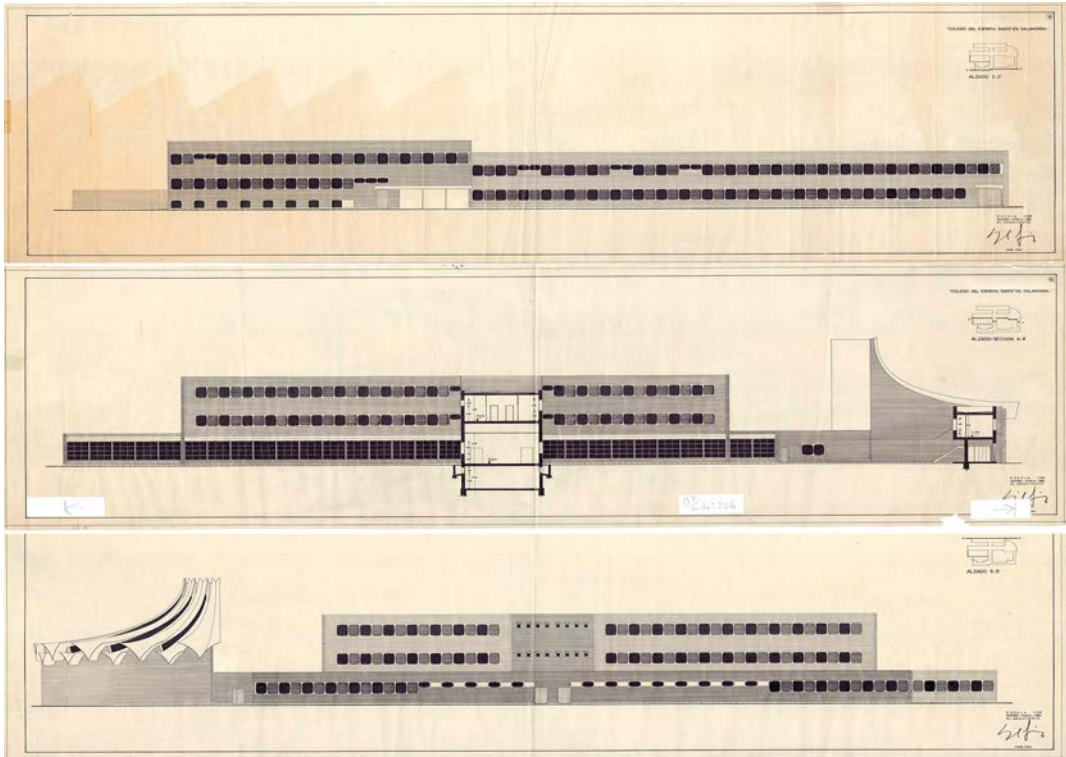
Planos de fachadas. Proyecto. (AFF, sig. 152).
